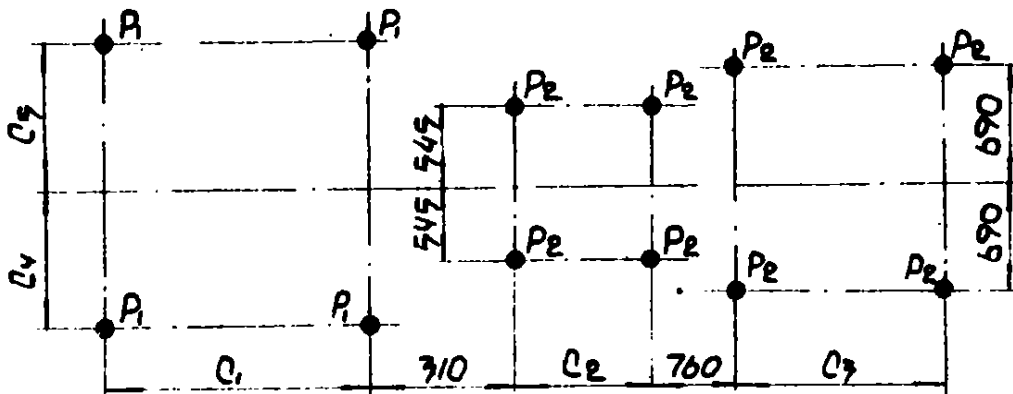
Схема распределения нагрузки на опоры от мельничного вентилятора типа ВМ-160/850У
